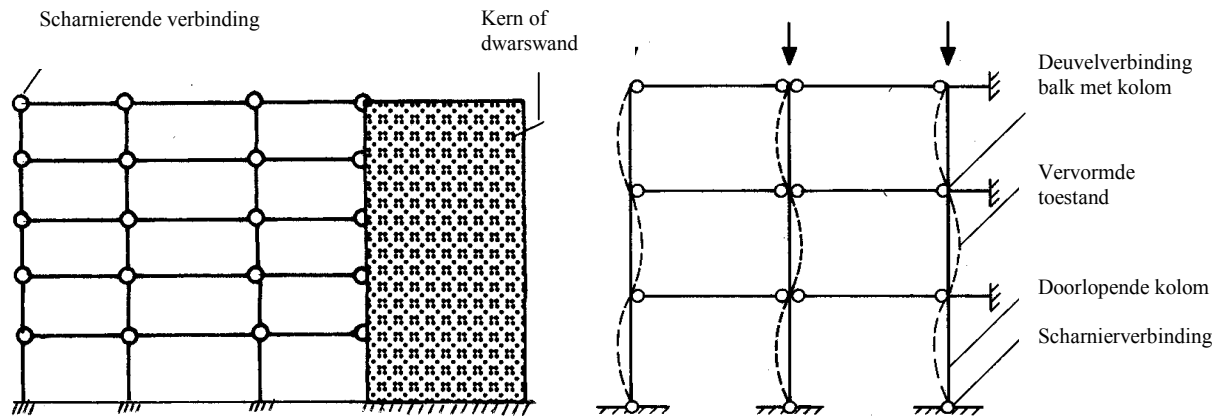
Voorbeeld van een geschoorde skeletconstructie en vervormingsschema
